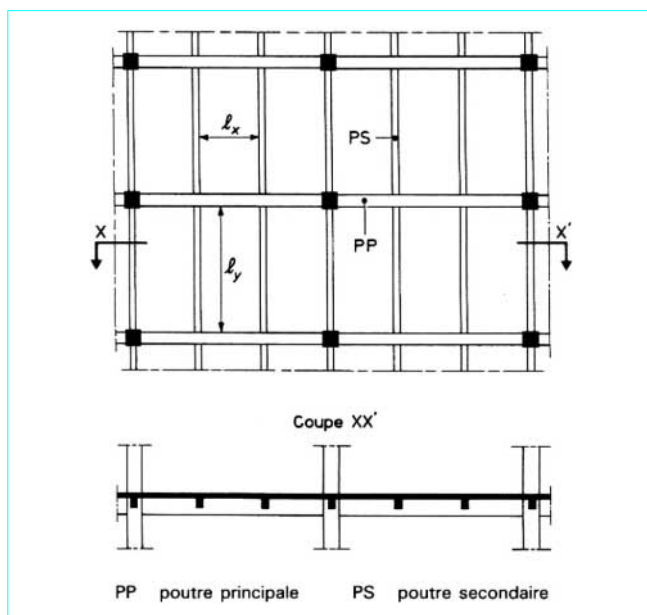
Plancher avec dalle générale, poutres secondaires et principales
